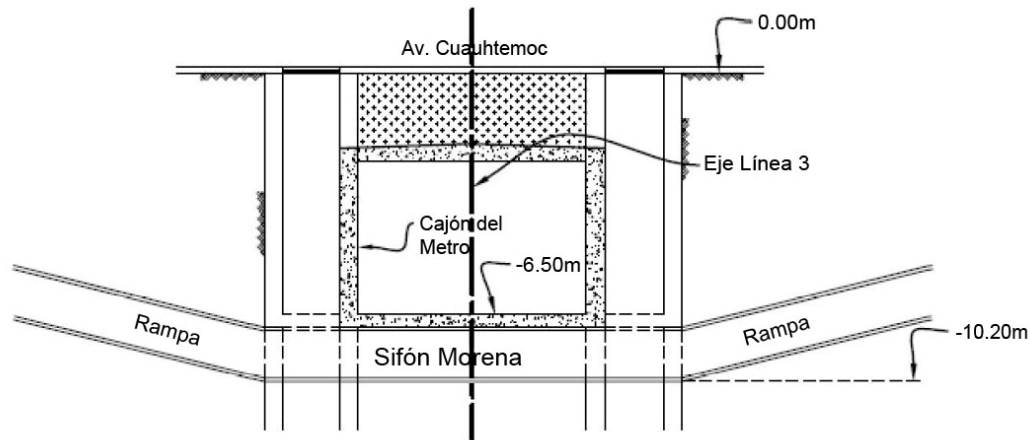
Corte longitudinal del Sifón Morena. (Corte A-A)
